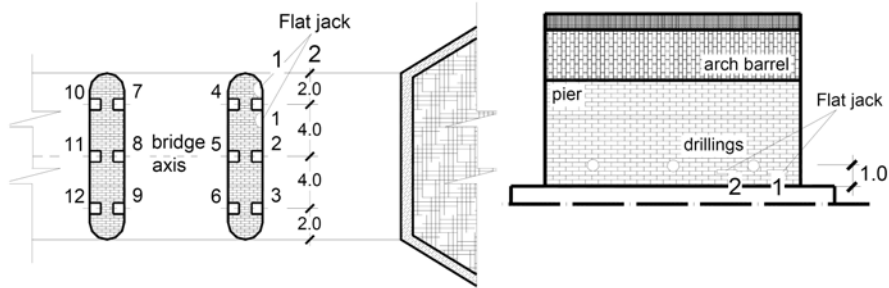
Planta y alzado con la localización de las perforaciones y de los gatos planos (Brencich et al. 2004).
